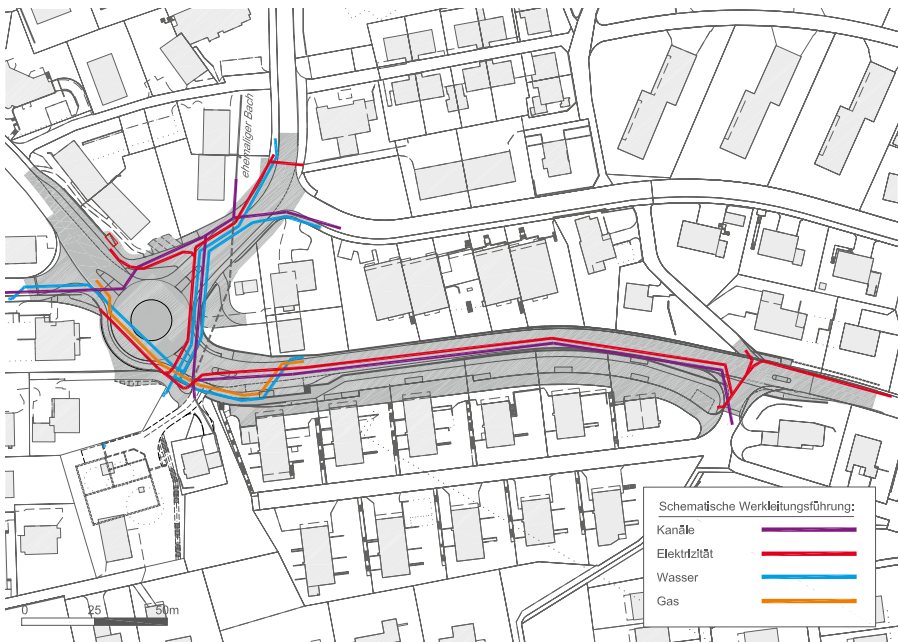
Sanierungsumfang Strassenbau, inkl. Werkleitungen
